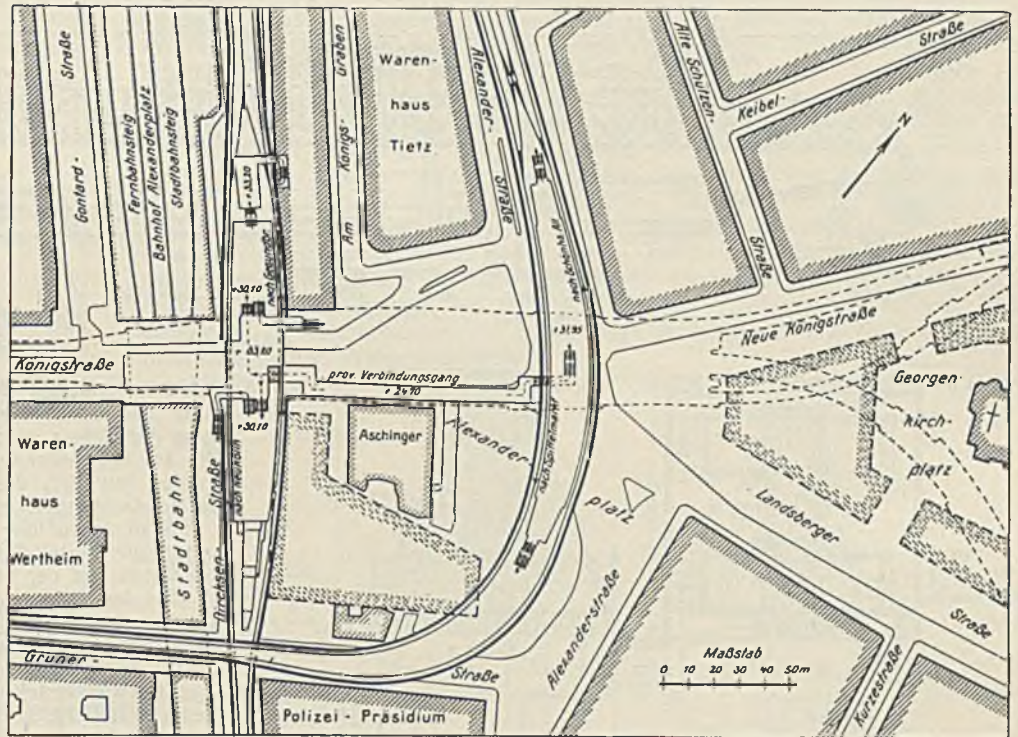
Lageplan des Bahnhofs Alexanderplatz. (Gegenwärtiger Bauzustand.)
